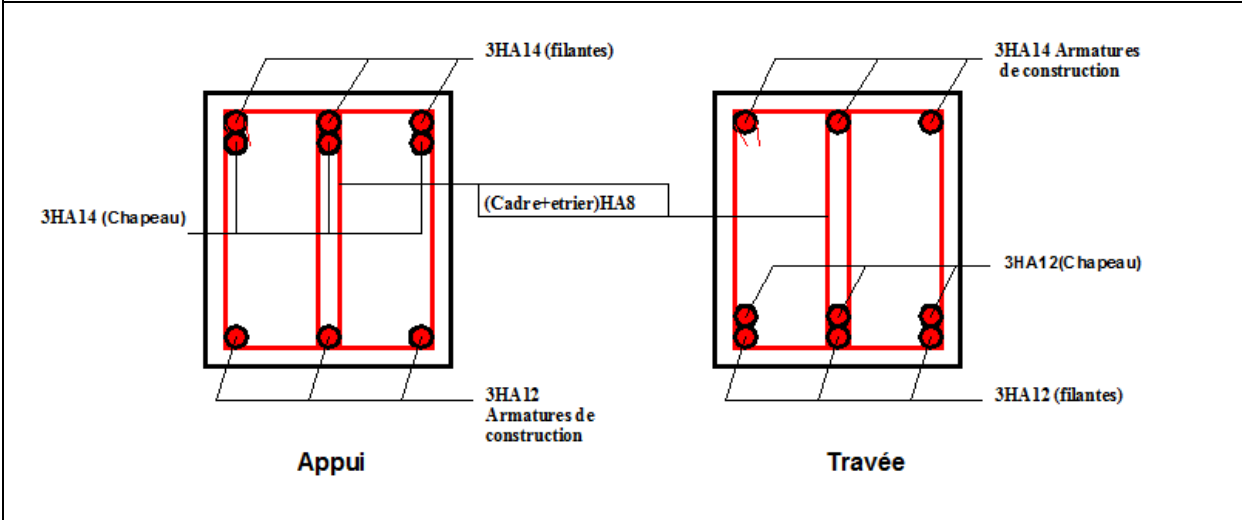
Schémas de ferrillages des poutres principales (Toiture).
